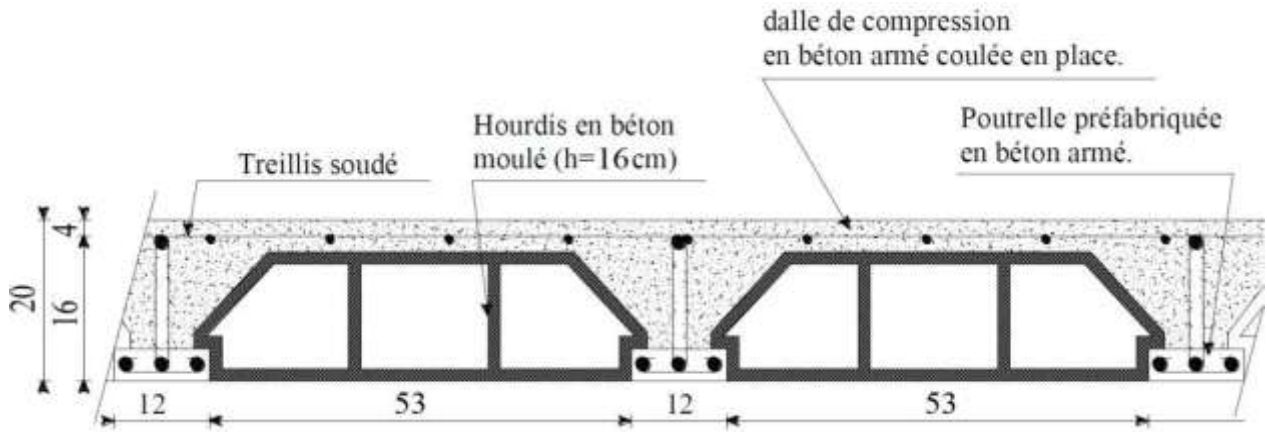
Illustration d'un Plancher en corps creux 16+4
